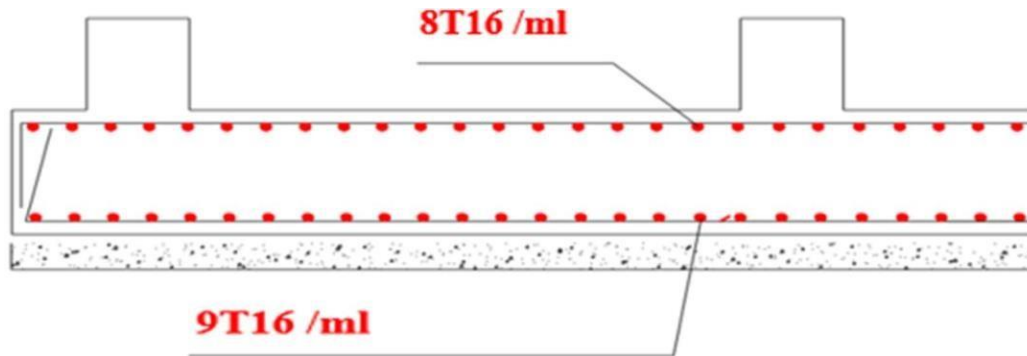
schéma de ferrailage de la dalle du radier sens x-x
